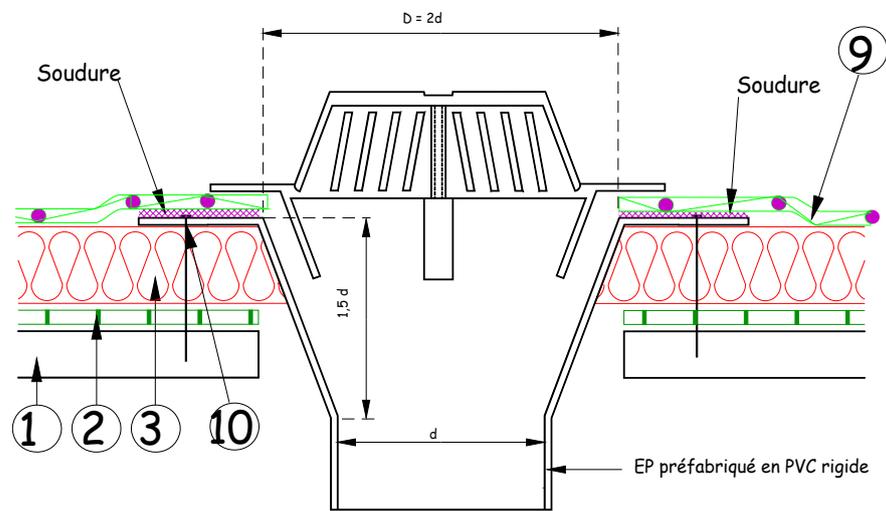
Entrée d'eau pluviale préfabriquée en PVC
